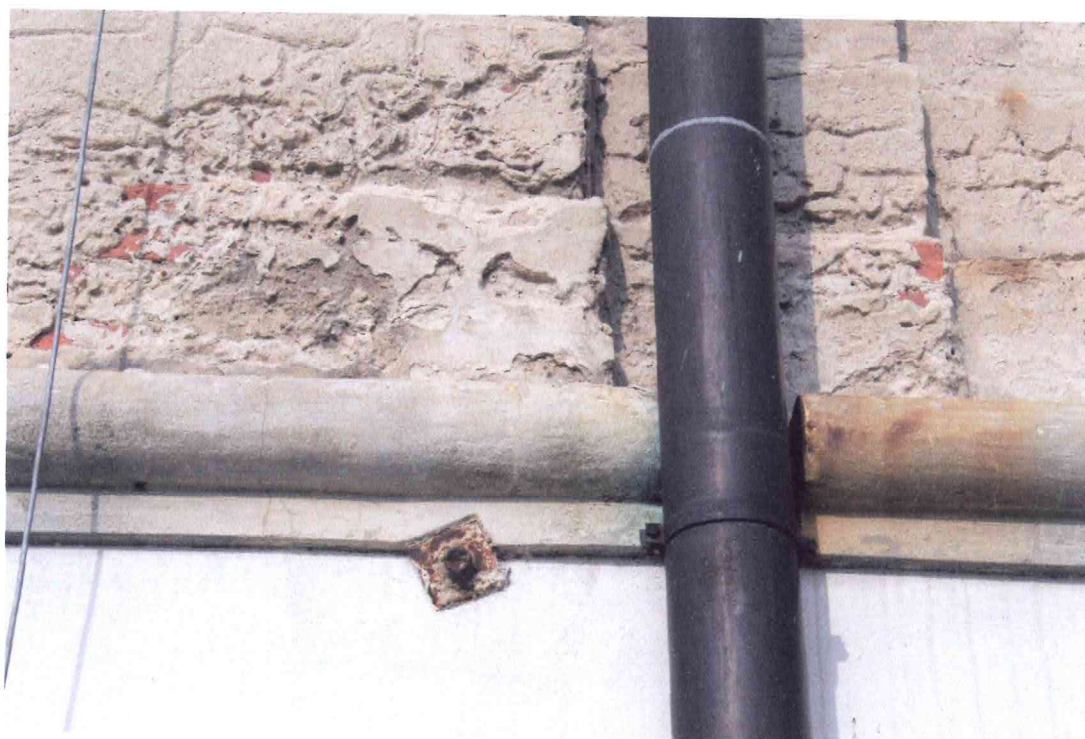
Radzyń Podlaski, Pałac Potockich, skrzydło wschodnie, elewacja wschodnia, fragment, stan przed konserwacją, październik 2008 r.
